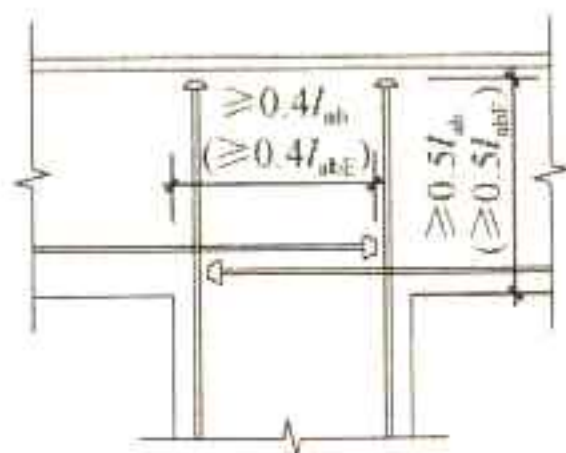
柱纵向钢筋和梁下部纵向钢筋在顶层中间节点的锚固
